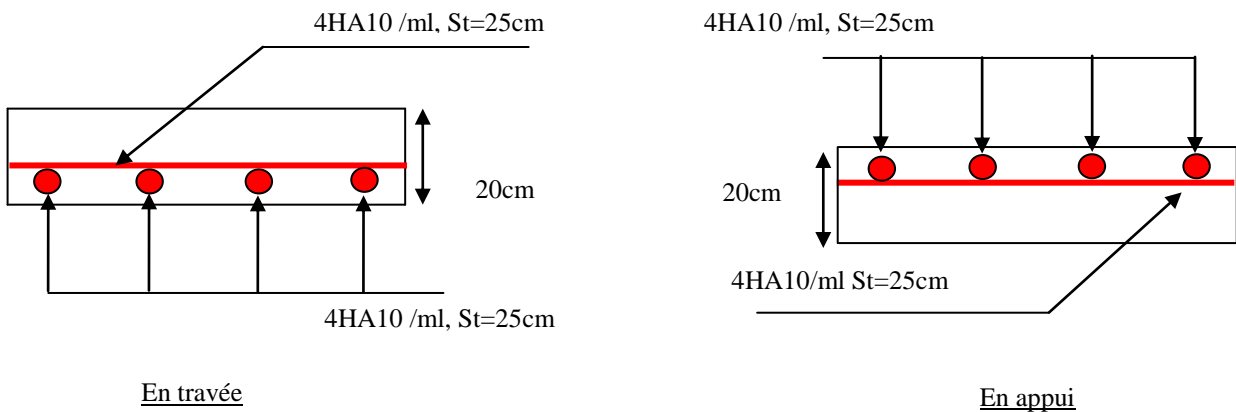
Schéma de ferrailage de la dalle pleine du local machine
